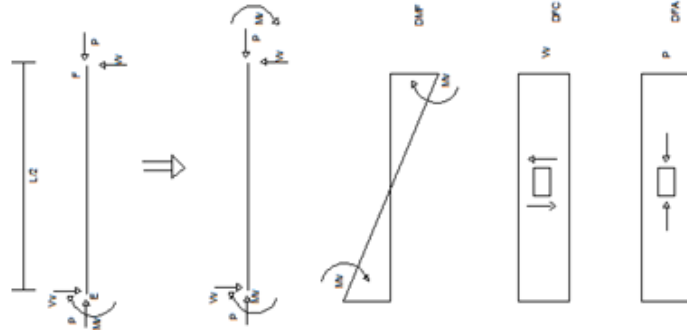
19 Momentos en los extremos de las columnas eje Y del sistema aporticado con muros de corte .
